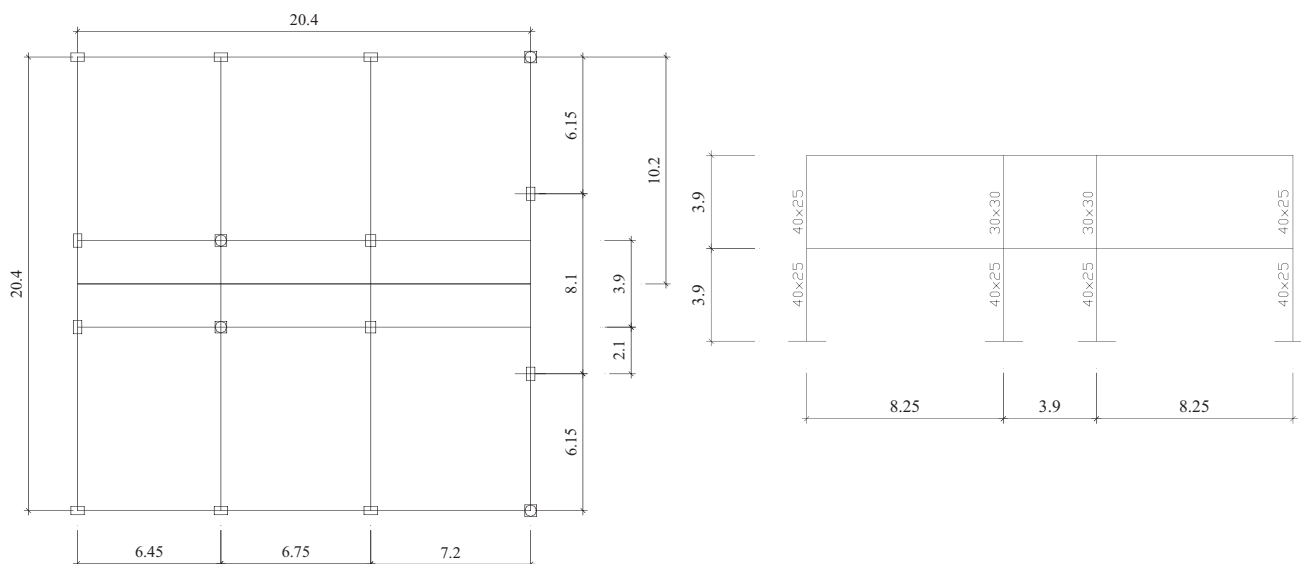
Planta y alzado edificio CASA. 2a) Planta edificio CASA. 2b) Alzado pórtico 2 del edificio CASA.
